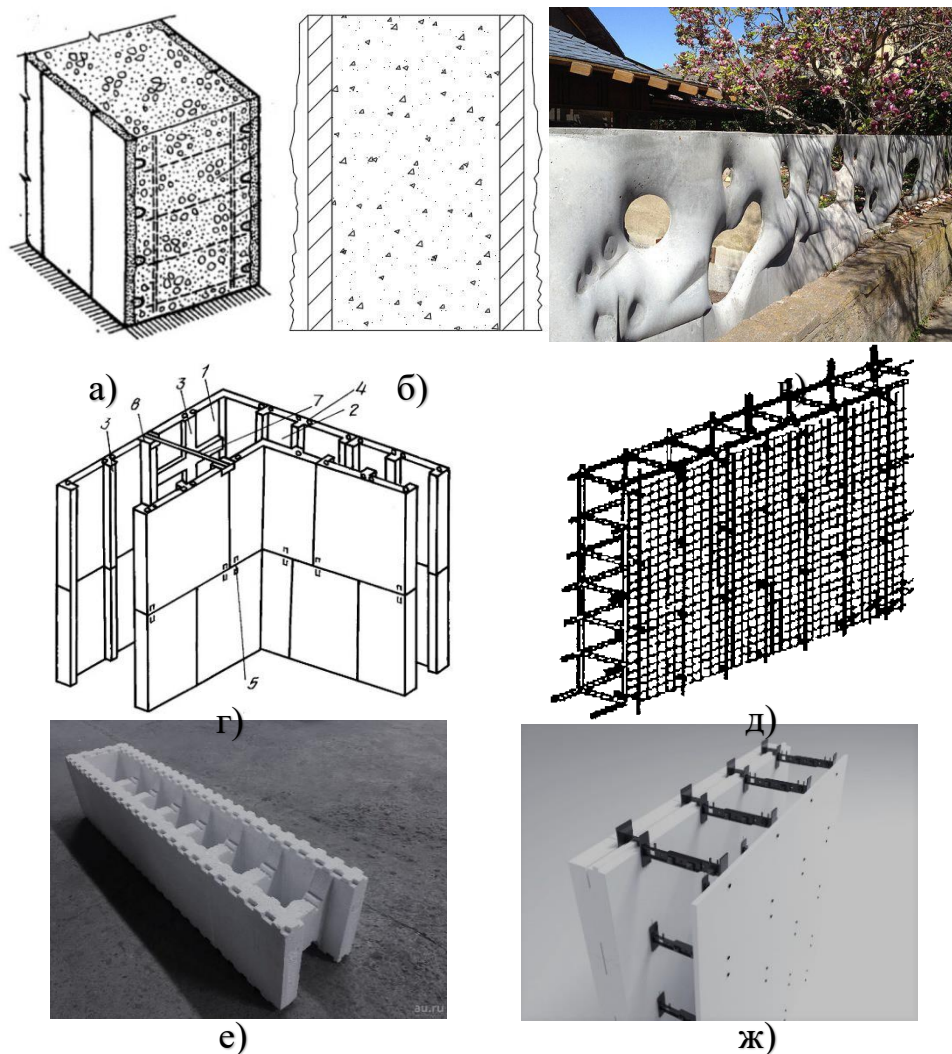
Несъемная опалубка: а – опалубка-облицовка; б – декоративная облицовочная опалубка; в – мягкая опалубка; г – металлическая опалубка-облицовка; д – сетчатая опалубка; е – блоки из вспененного полистирола с пустотами; ж – стекломагнетитовая каркасная опалубка.
